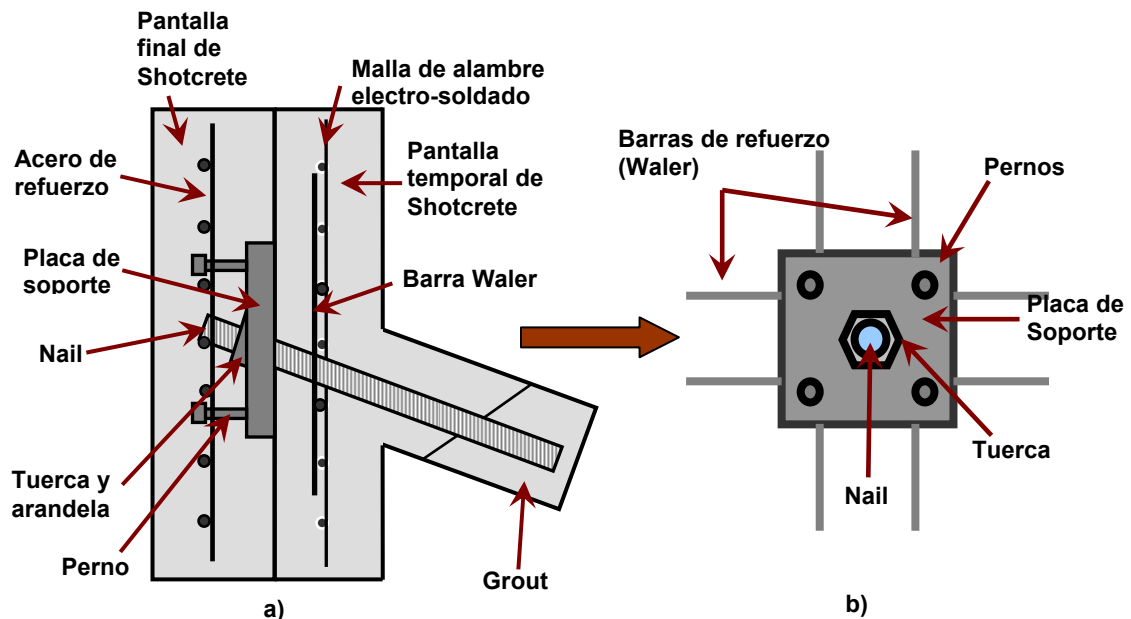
a) Pantalla temporal de Shotcrete; b) Barras (Waler) en cabeza del Nail.
